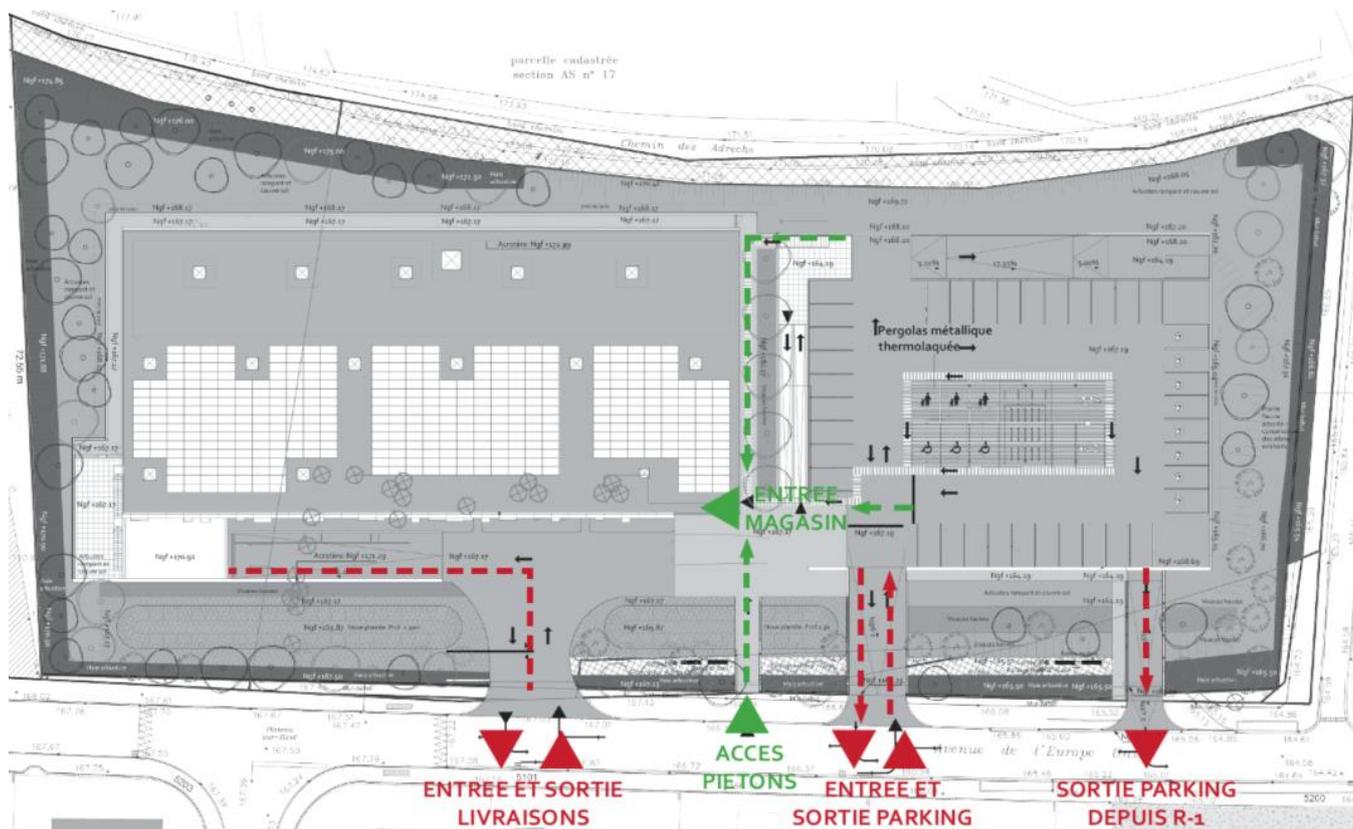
Plan des accès à la future surface commerciale depuis l'Avenue de la Libération (Source : Notice architecturale et paysagère – TANGRAM Architectes – 03/2021)
